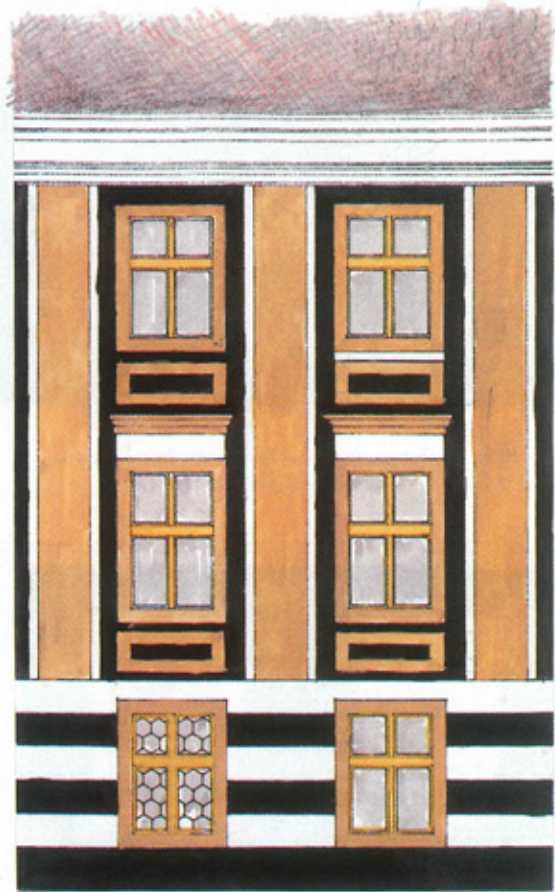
Rekonstrukcja schematu kolorystycznego elewacji pałacu w Maniowie Małym (oprac. autora)
